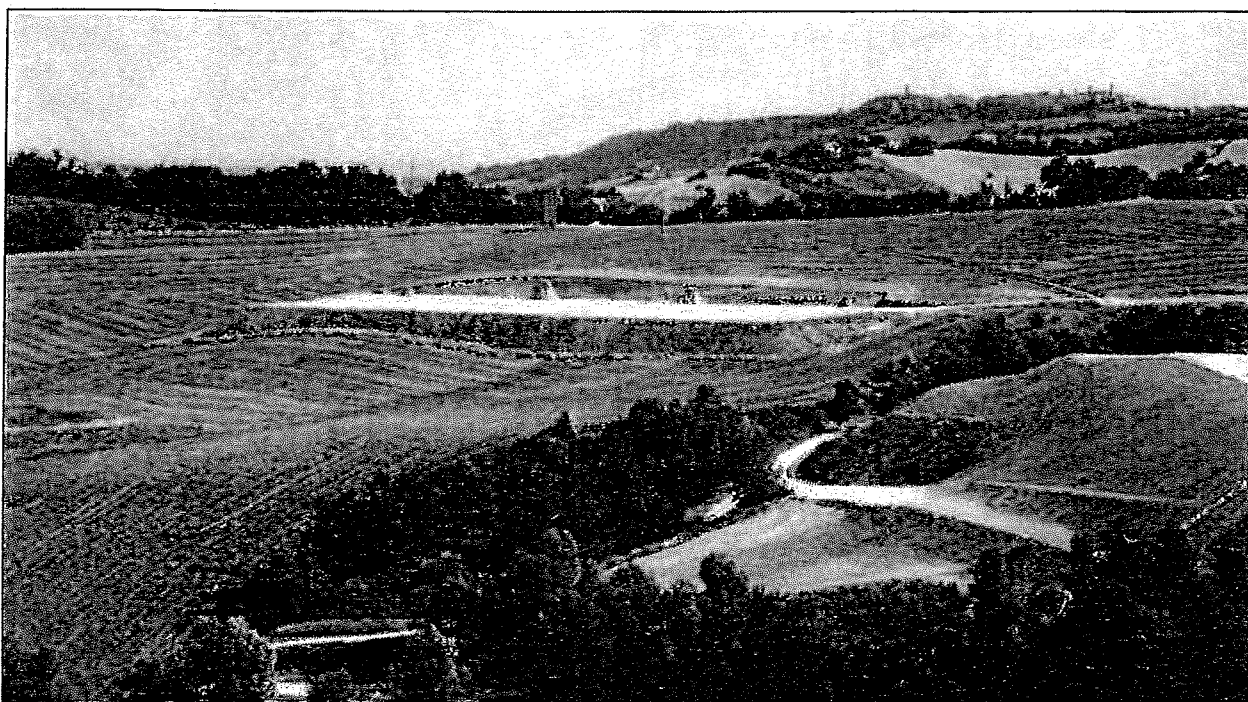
Vista panoramica da W dei lavori di realizzazione dell'impianto di compostaggio
